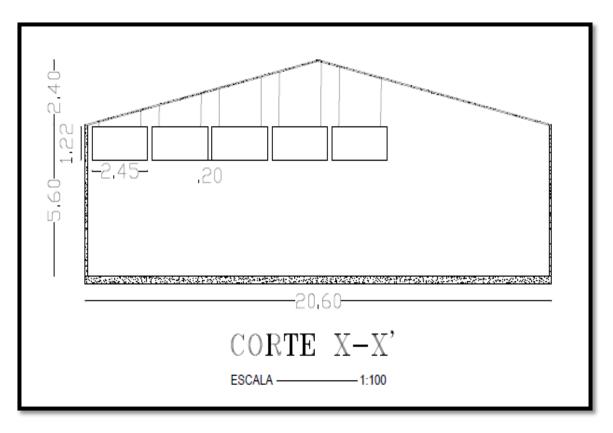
Corte en la sección x de las instalaciones del CCICEV para establecer disposición, dimensiones y espaciamiento entre los paneles
